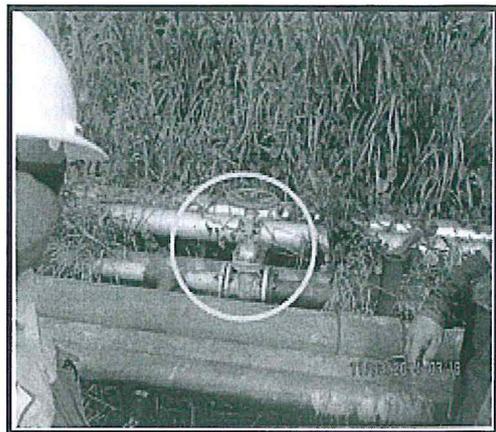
Vista de la válvula de donde ocurrió el derrame y se reparó la avería cambiando la empaquetadura.
